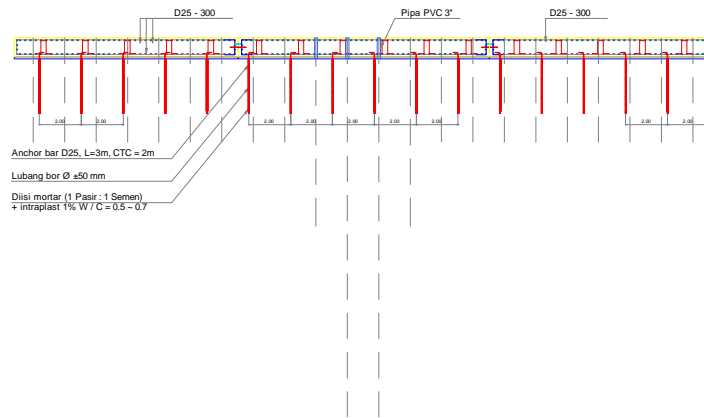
BOQ Pekerjaan *Drilling Dan Grouting*.
